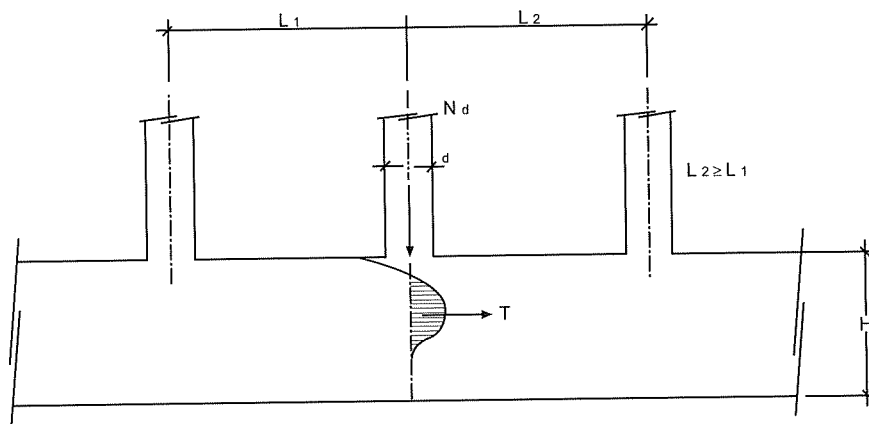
(Tomada de Cálculo de Estructuras de Cimentación, 4ª edición - J. Calavera)
